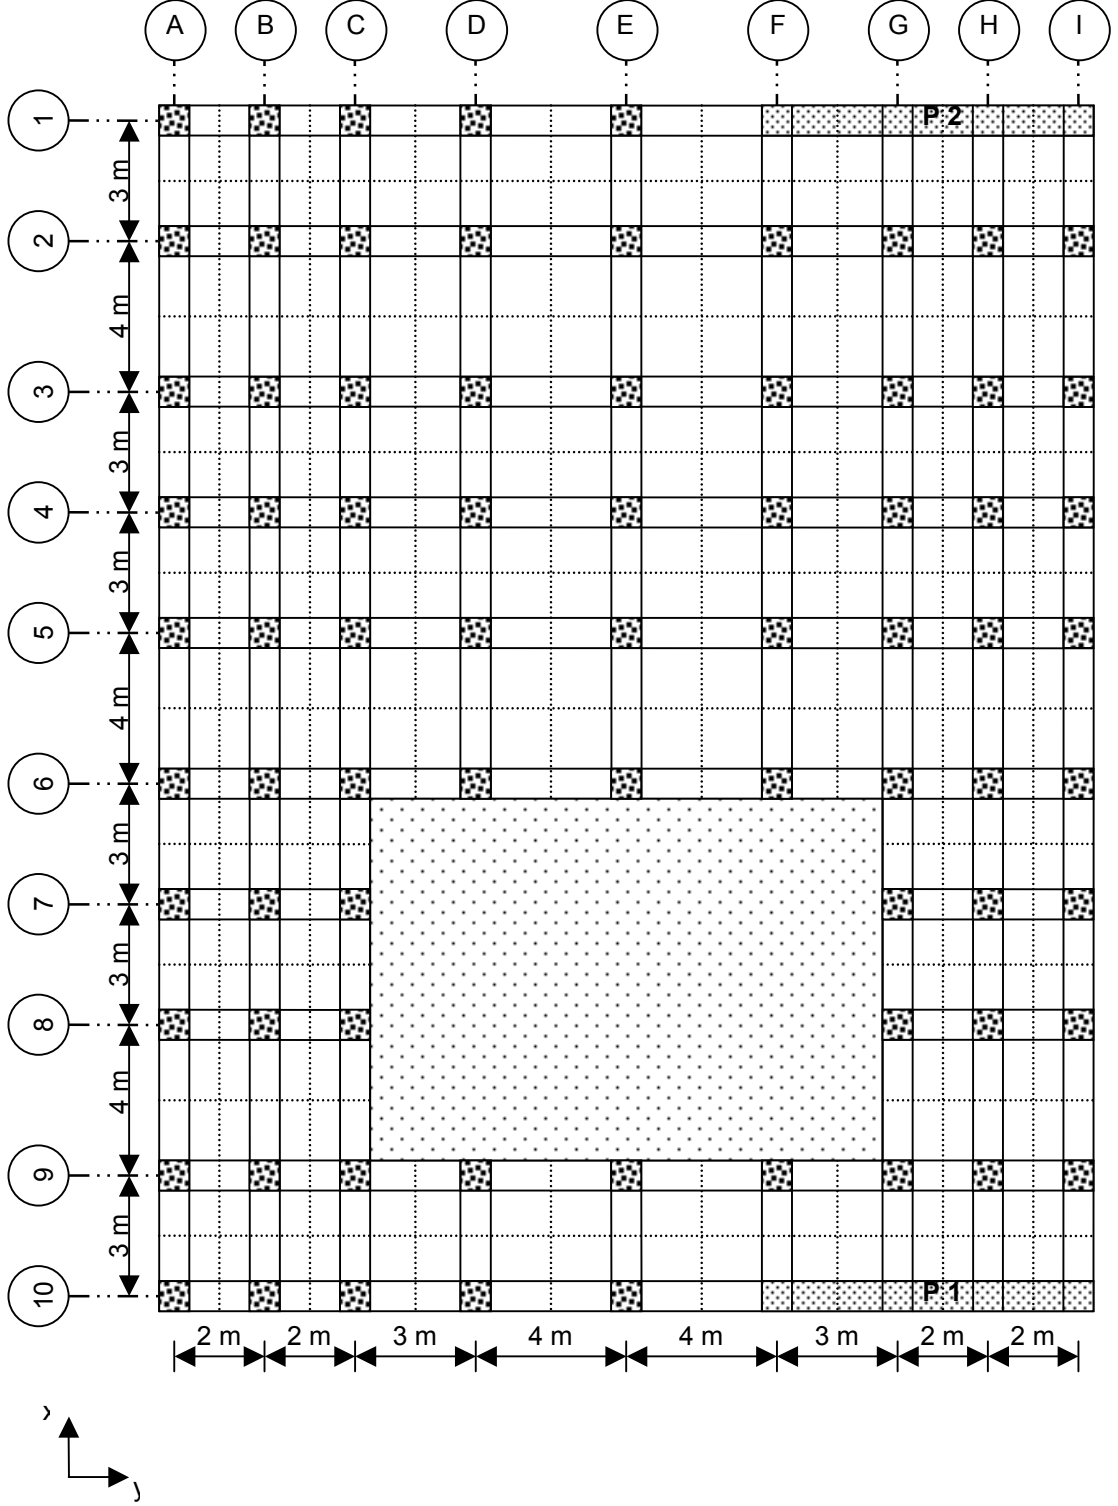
Örnek 5.12'in kat kalıp planı
